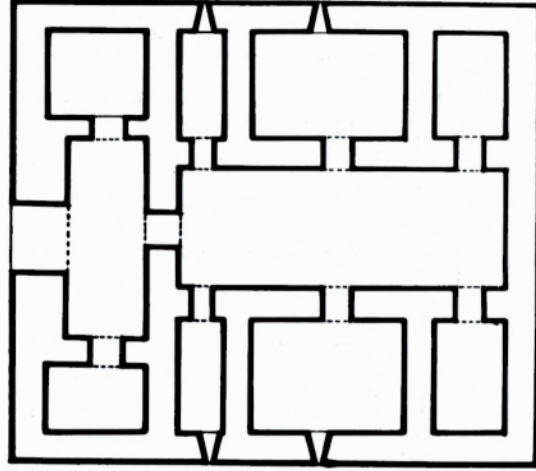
Erkelet, Hızır İlyas Köşkü Planı (A. Tükel'den)
